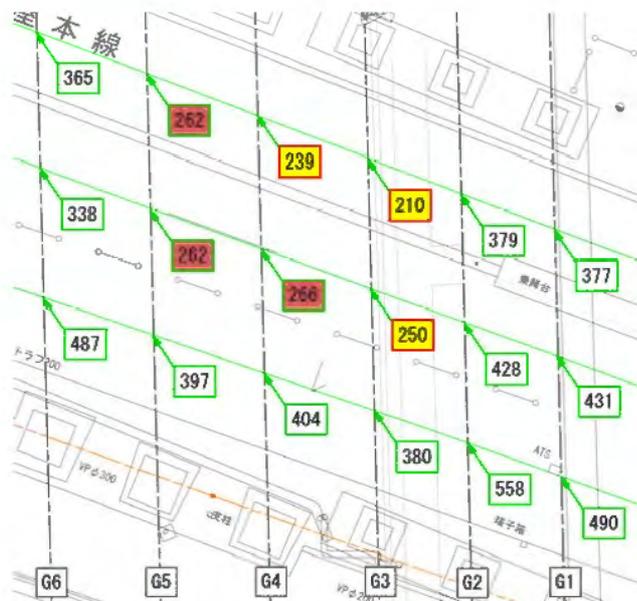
名鉄架線と主桁下フランジとの離隔図(平面図)
